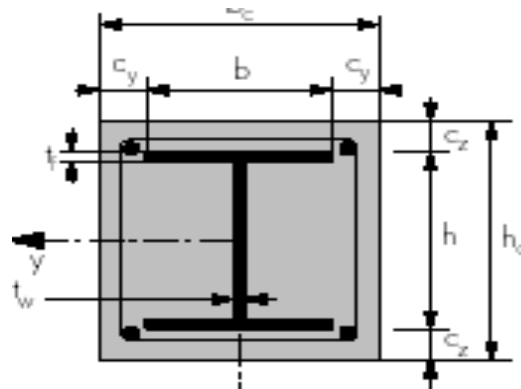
Poteau mixte totalement enrobé de béton.
